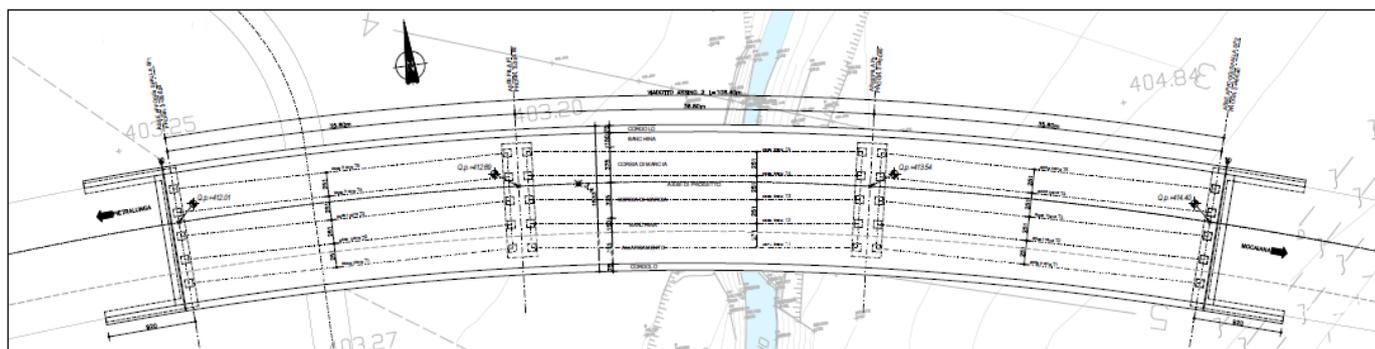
PLANIMETRIA VIADOTTO ASSINO 2
